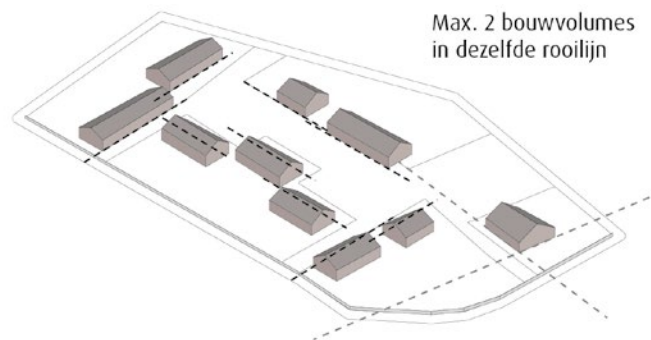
De Erfbebouwing vormt een compact bebouwingsensemble. Het Entreegebouw staat hier los van.
